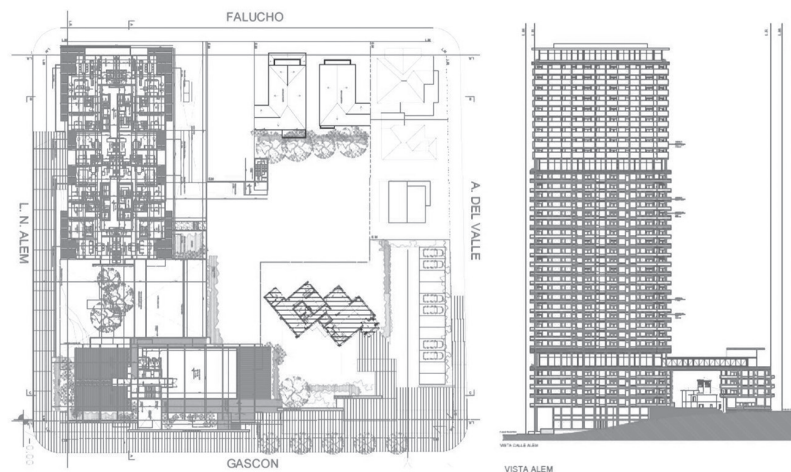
Planta y corte del proyecto presentado. Fuente: Expediente N°1865-D-2024.
